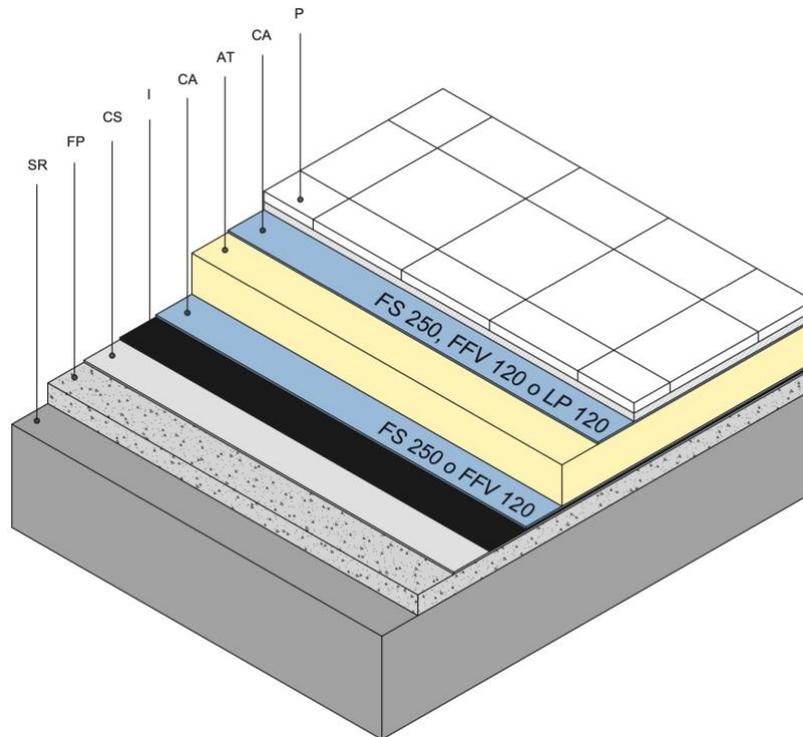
Posición capa antiadherente en cubierta invertida. Leyenda: SR Soporte resistente. FP Formación de pendiente. CS Capa separadora. I Impermeabilización. CA Capa antiadherente. AT Aislante térmico. P Protección (pavimento fijo con mortero de agarre).
